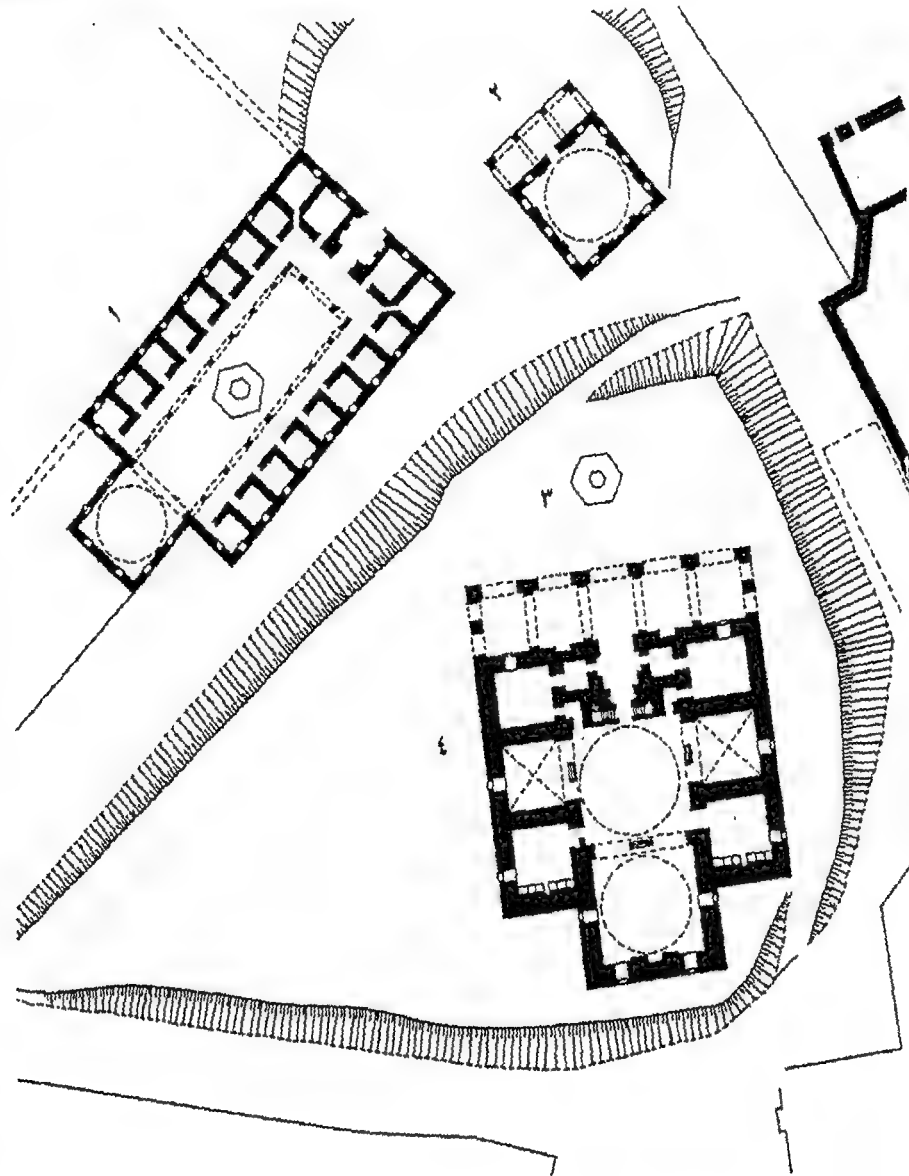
مسقط أفقي لمسجد طاش ذي القبة وتتقدمها سقيفة (٦١٢ هـ / ١٢١١ م).
